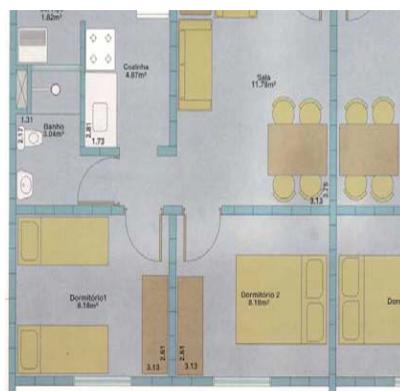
planta CDHU tipo VI-22 F – Caderno de Tipologias de edificações da CDHU. Área das unidades 37,81 m² com dois dormitórios.
